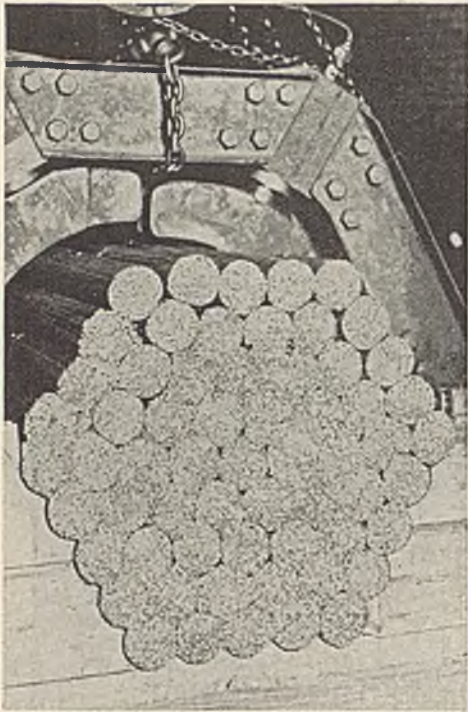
Kabel in Sechseckquerschnitt vor dem Zusammenpressen.
